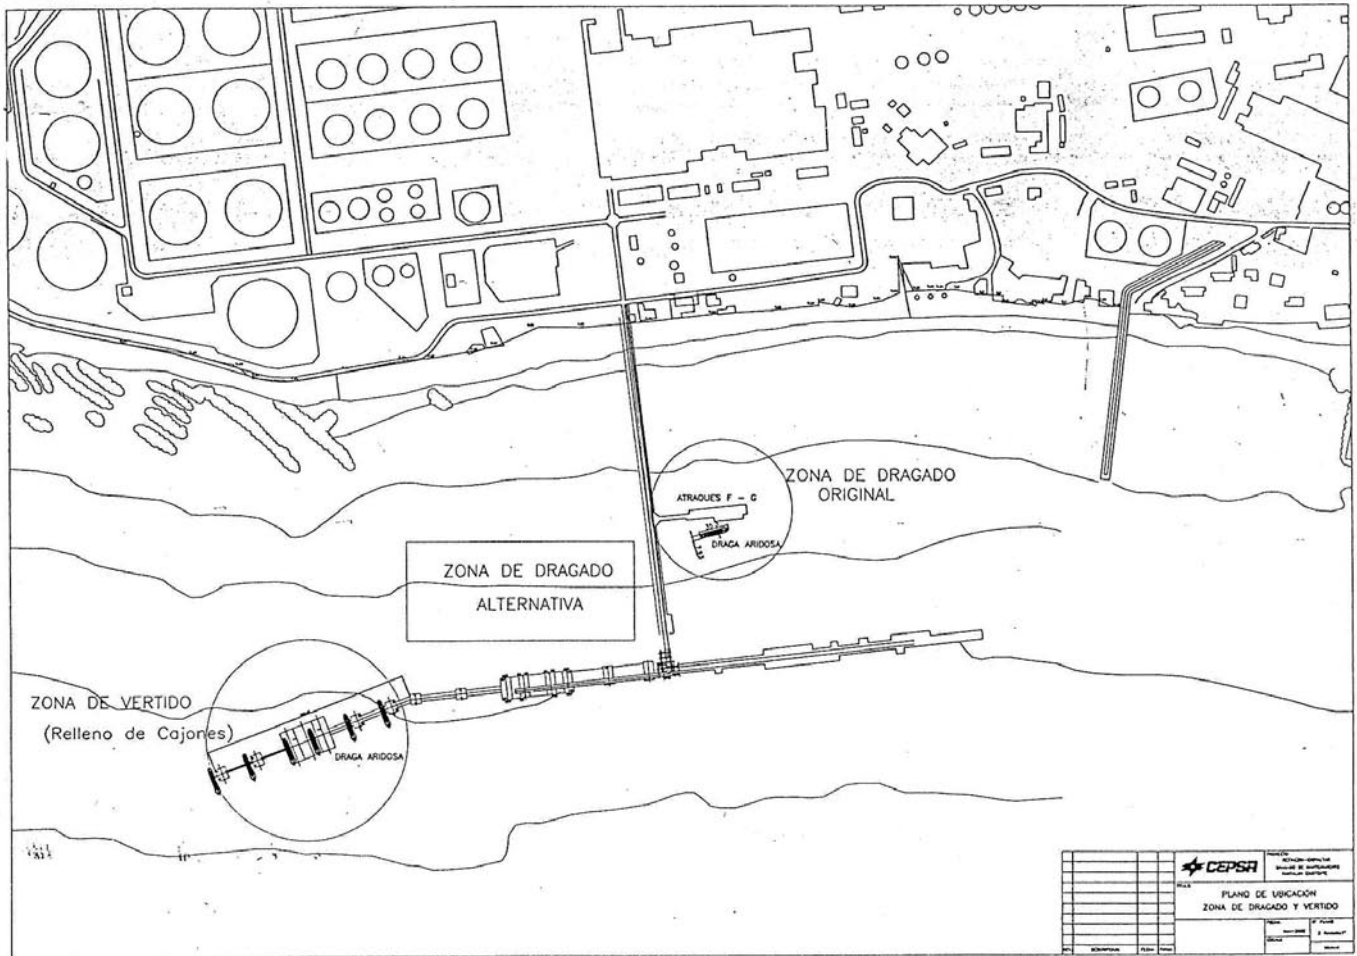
Plano de ubicación de las zonas de dragado y vertido.
